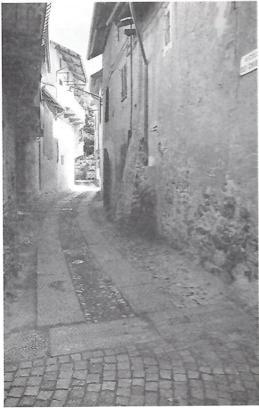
Pavimentazione originaria in acciottolato con guide e nuova pavimentazione in selciato (Via Roma).
